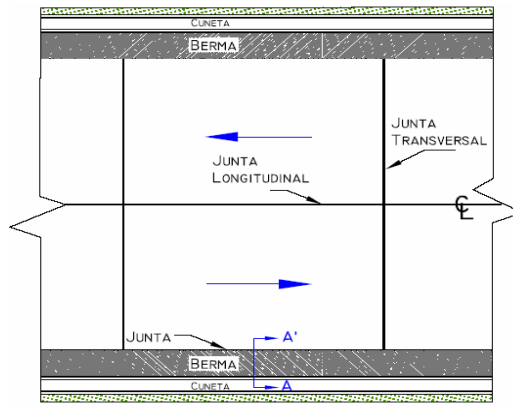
Bombeo sobre la junta transversal o longitudinal
